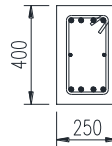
Detail Penjangkaran dan Sambungan Lewatan *Tie Beam
